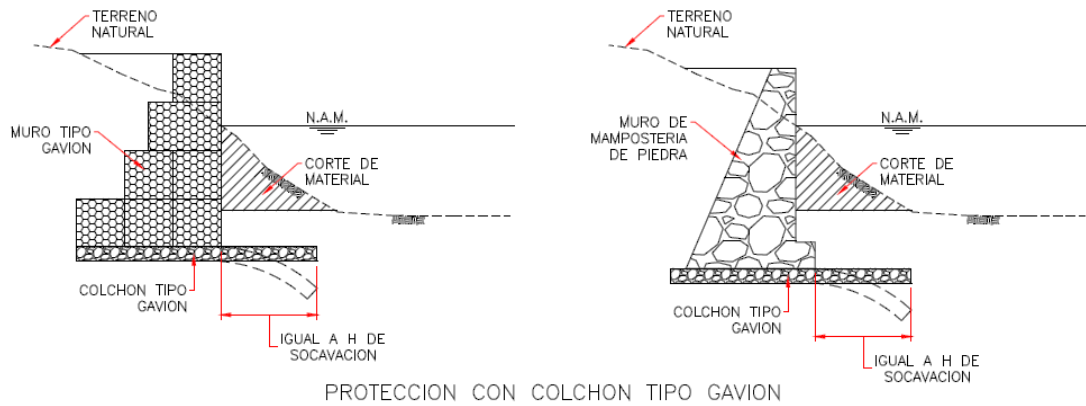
Protección para muros de márgenes con colchón “Reno” (Tipo Gavión).
